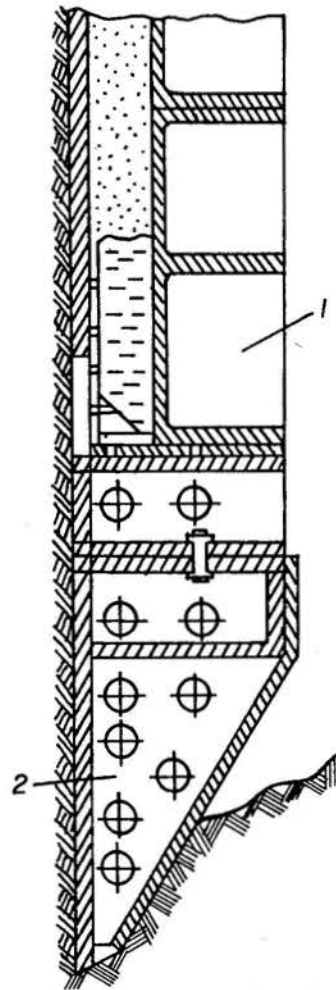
Partes constituyentes de la fortificación de descenso. 1 - pared, 2 - zapata.
